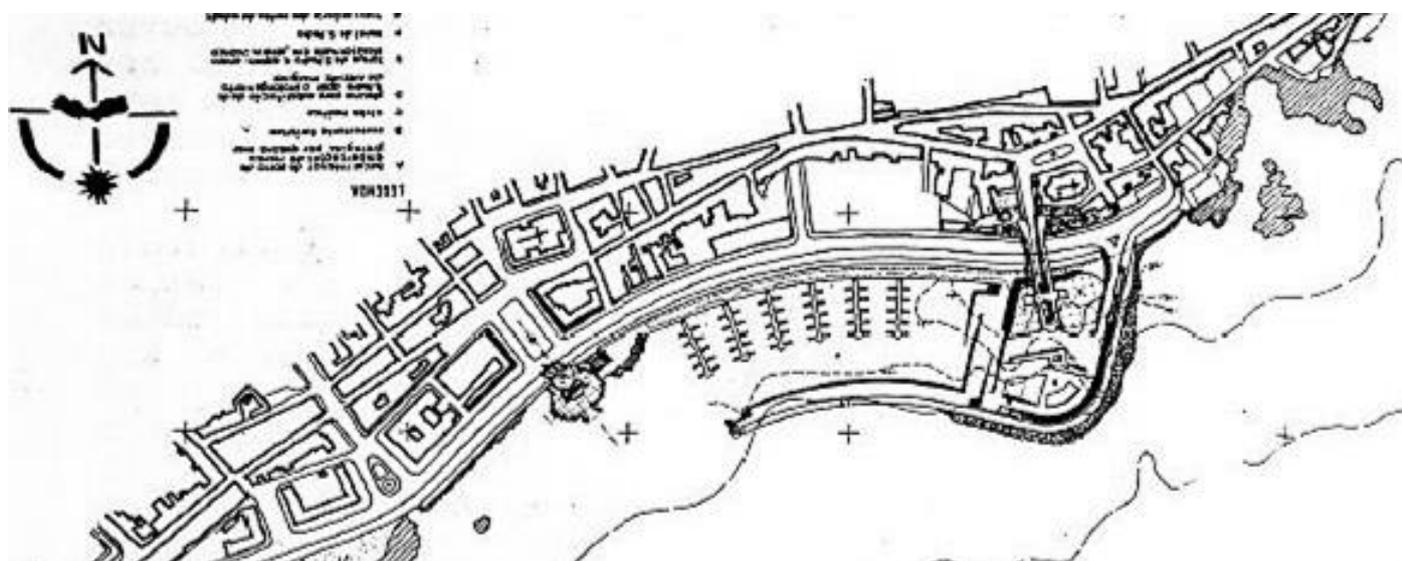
Planta de Localização da proposta do Arq. Luiz Cunha para um Complexo Náutico em Ponta Delgada, 1977.
